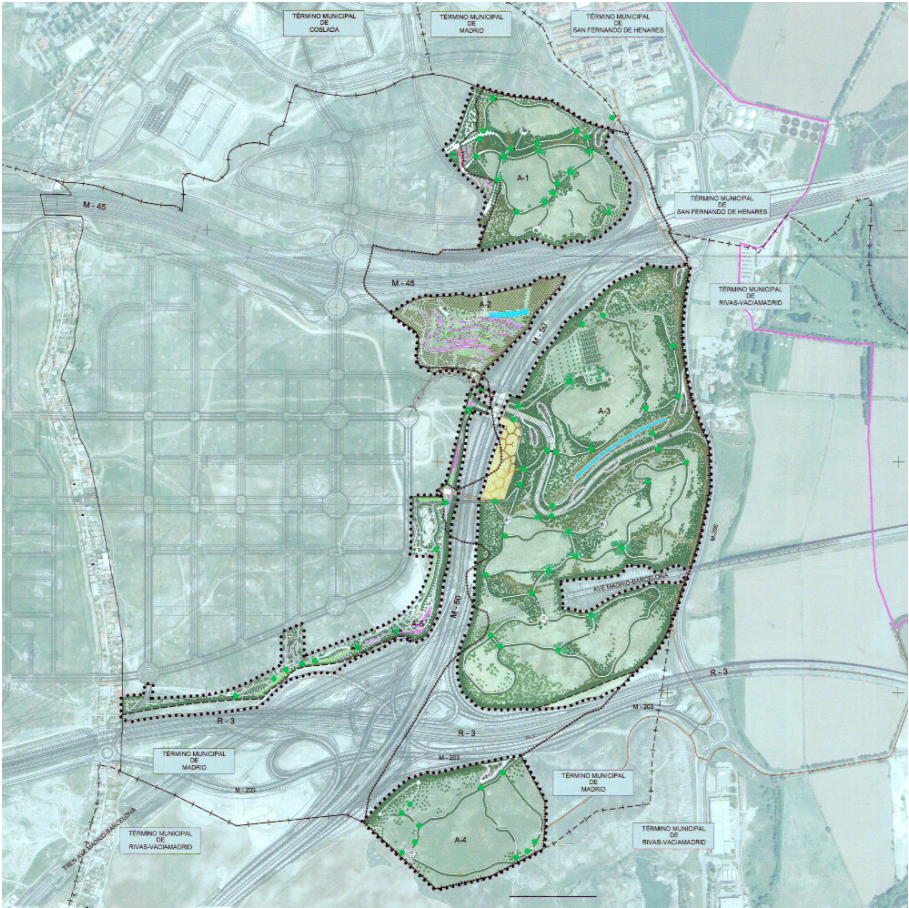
Planta general de la propuesta de ordenación del PE Cerro de la Herradura aprobado en 2010
